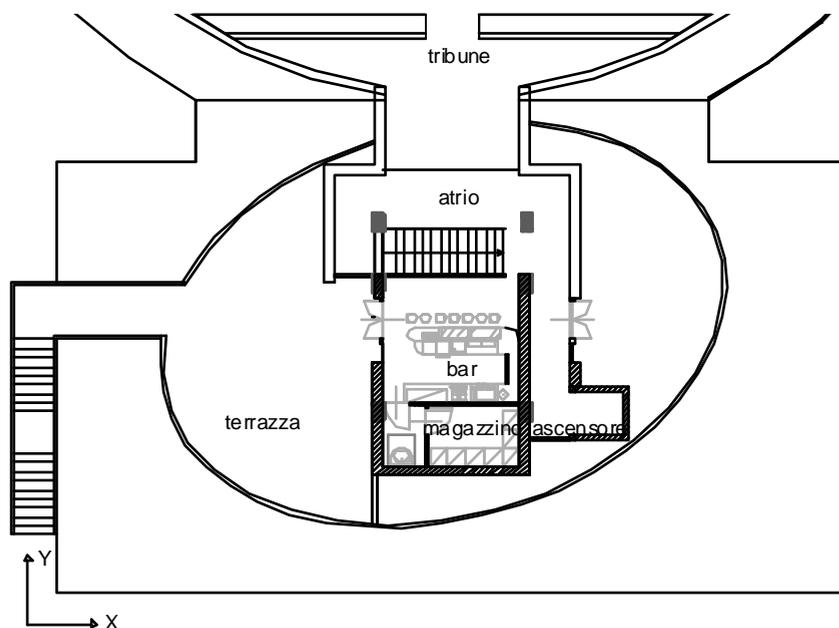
Soluzione strutturale adottata per la sopraelevazione. Tratteggiate le pareti XLam e evidenziati in grigio i pilastri in c.a. della struttura sottostante.
